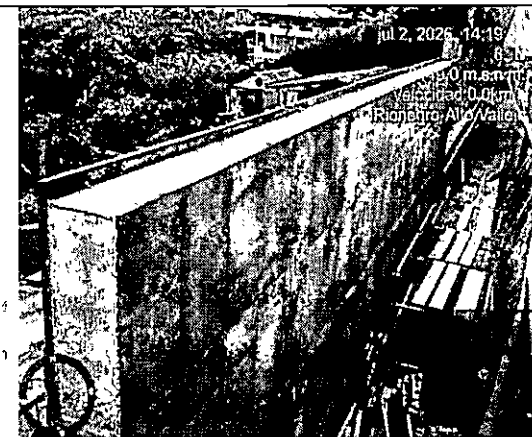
Desencofrado de elemento estructural vástago tramo 1 / s2.
